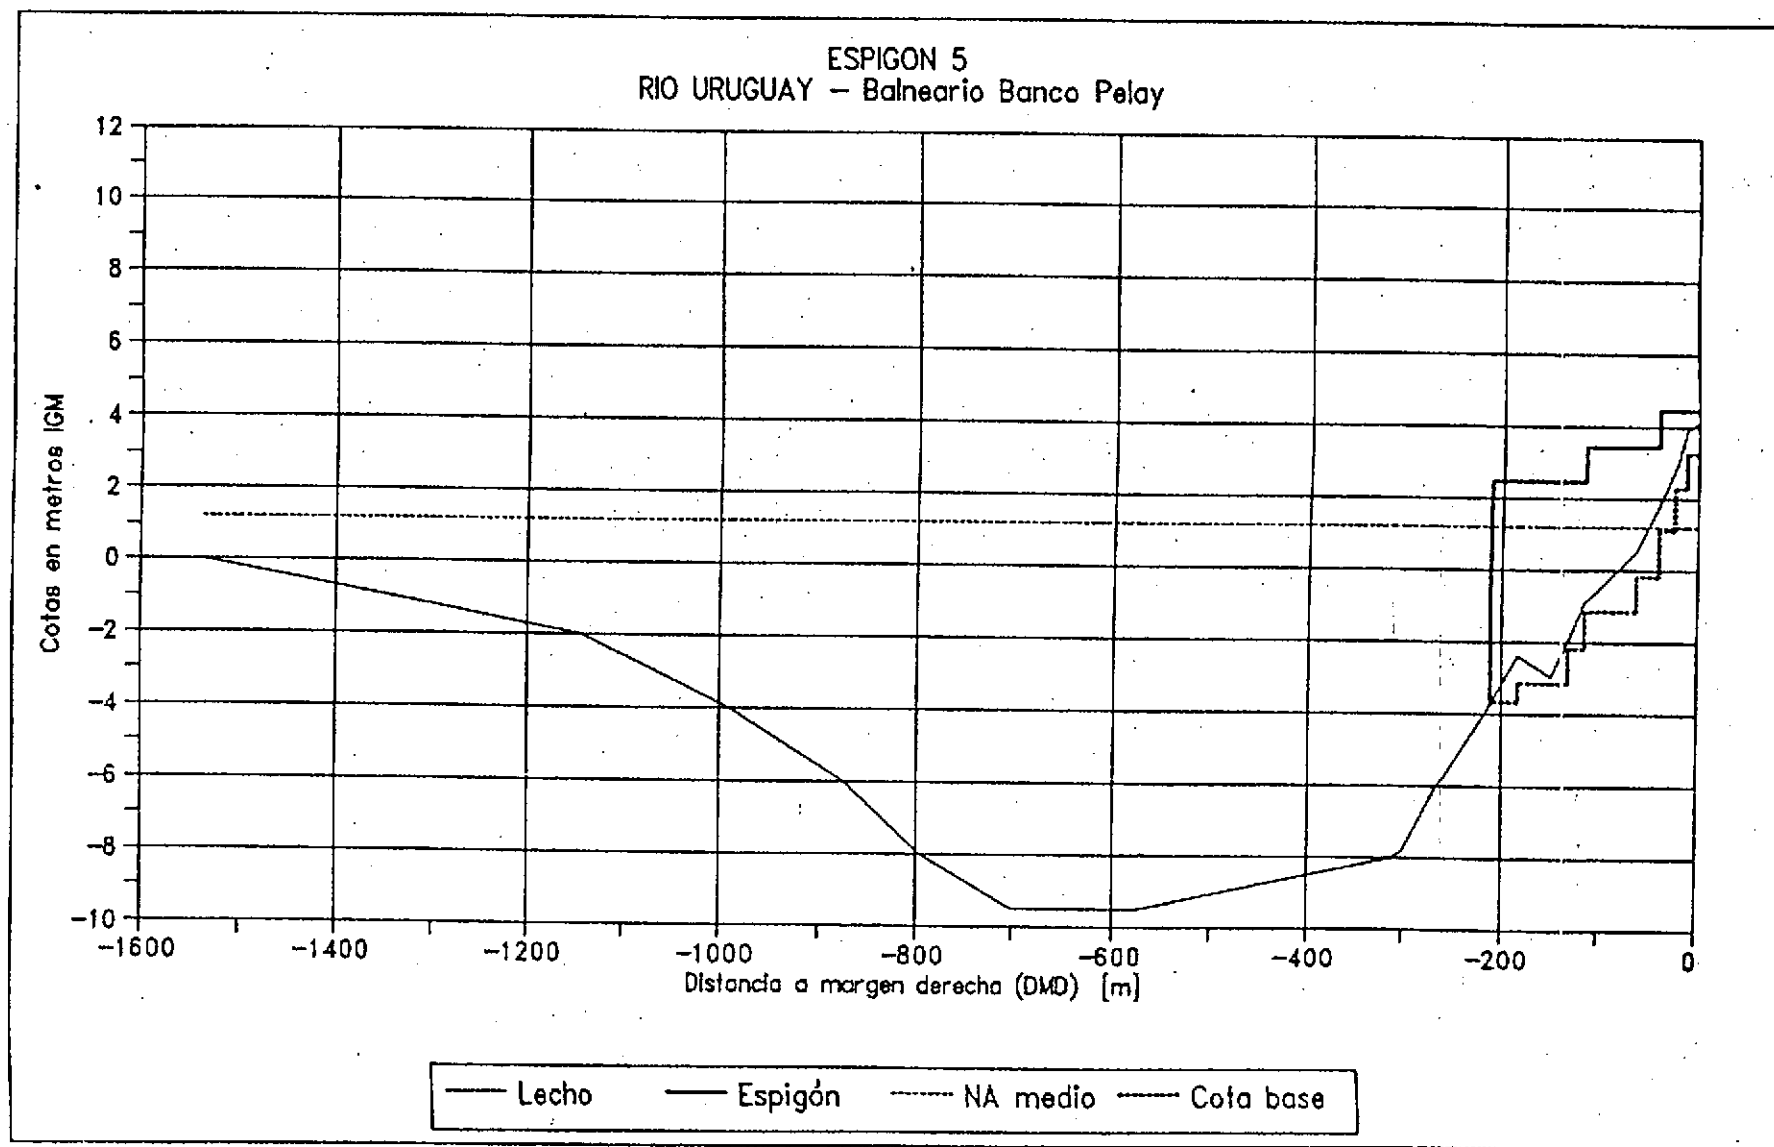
Perfil Transversal Río Uruguay según eje Espigón 5.
